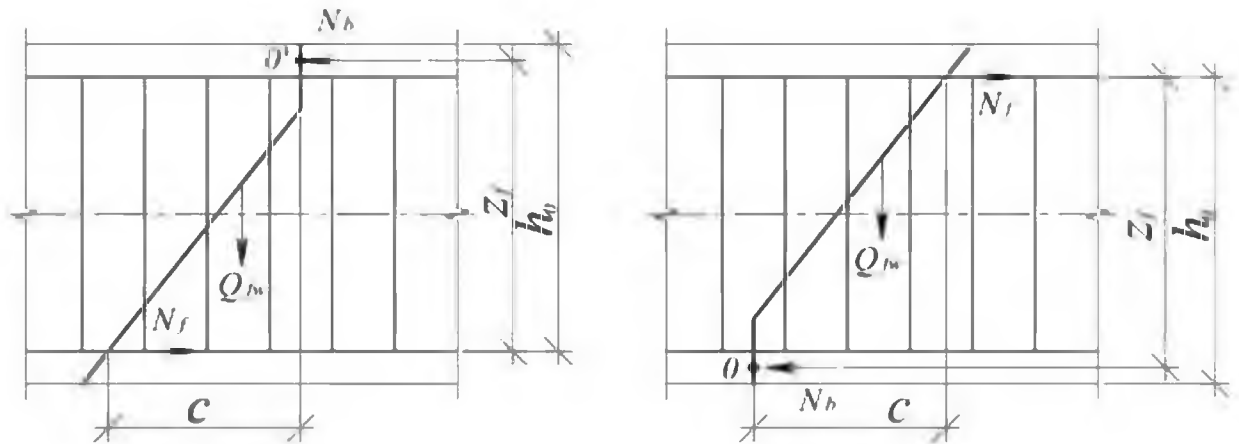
Схема усилий при расчете конструкций по наклонному сечению на действие моментов
